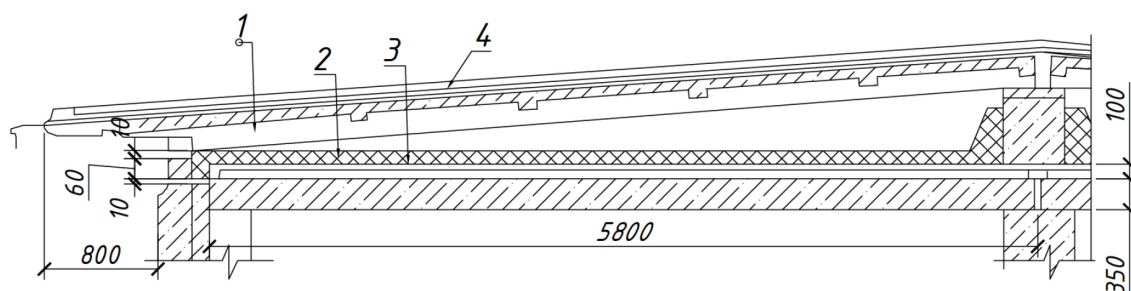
Конструкция бесчердачной вентилируемой совмещенной крыши: 1 – железобетонная ребристая плита покрытия; 2 – утеплитель; 3 – пароизоляция; 4 – четырехслойный рулонный ковер с верхним профилированным слоем
